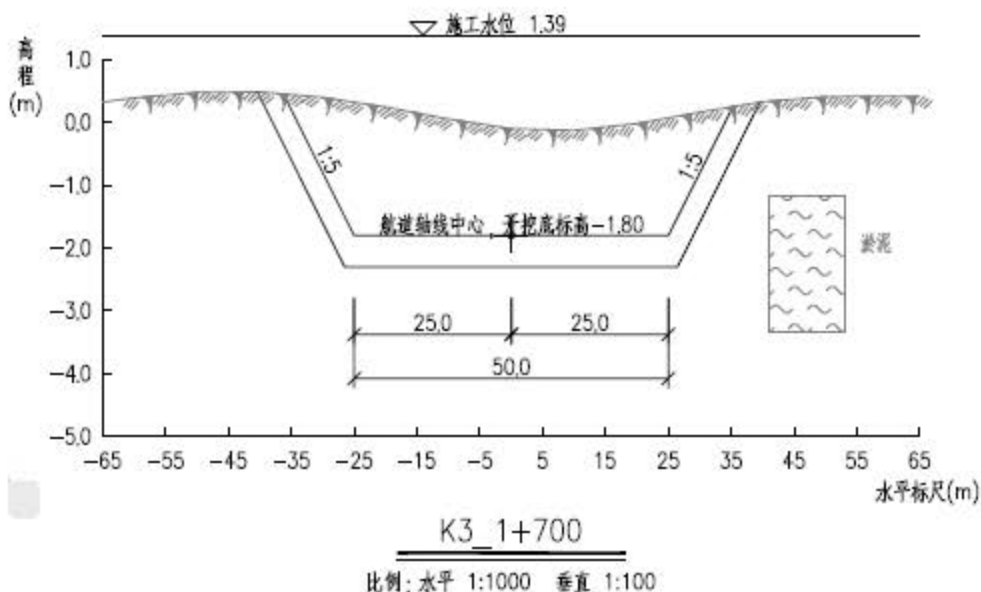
广海渔港施工临时航道疏浚横断面
